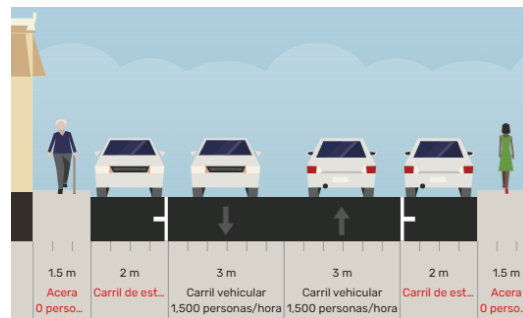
Avenida de la Cantera. Fuente: SIGMUN 2025.
